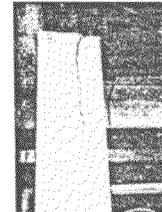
Grieta diagonal en una de las caras de la columna.
